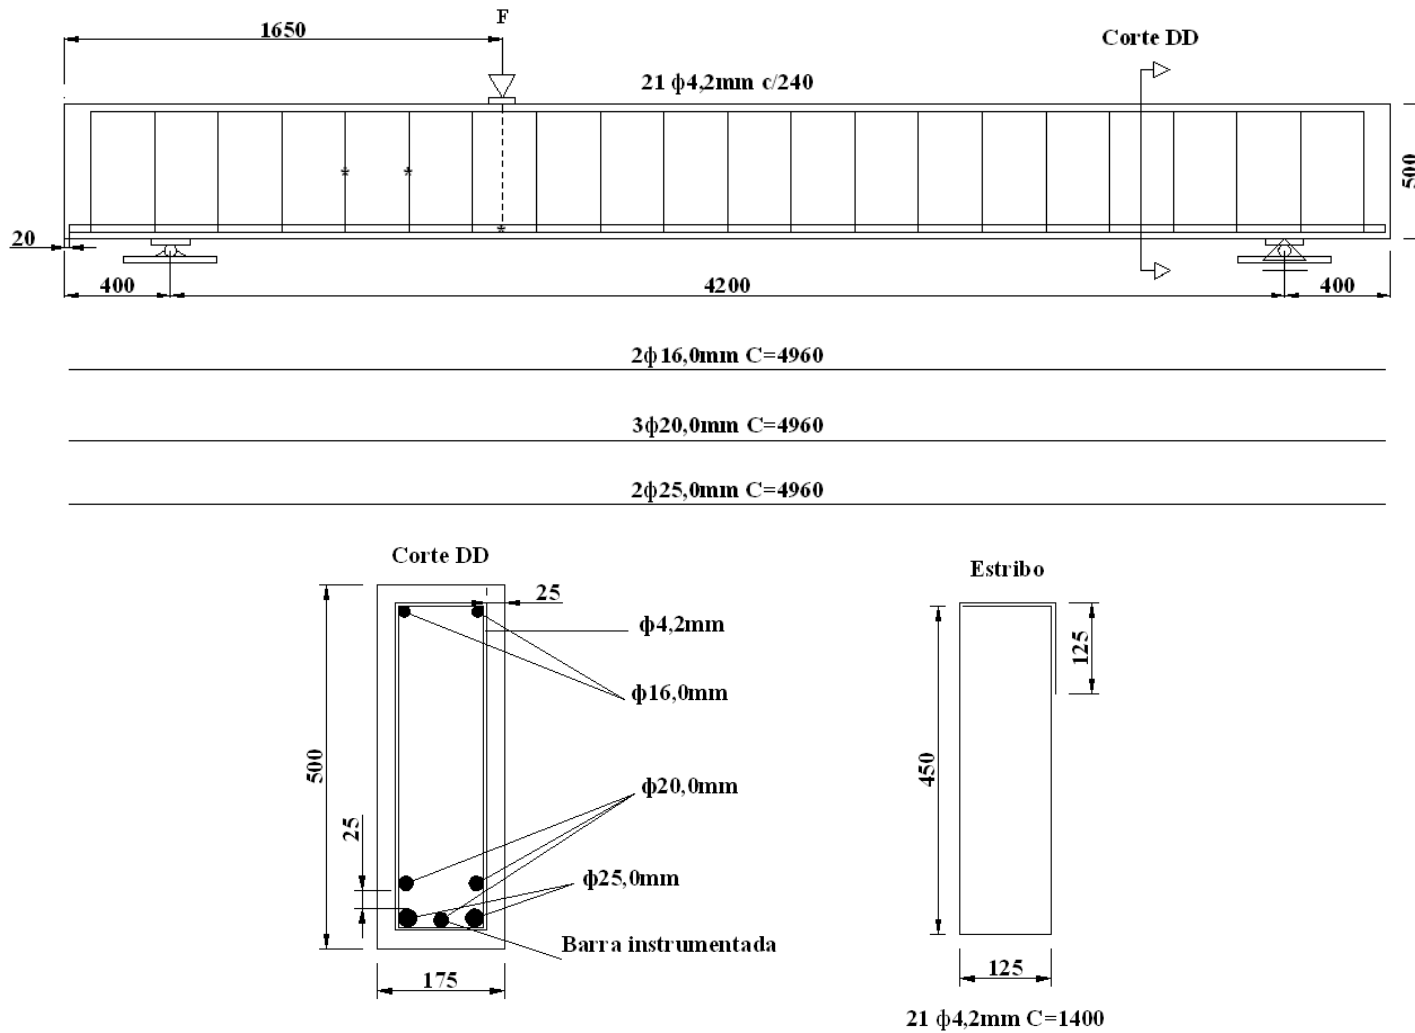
Armaduras e posicionamento dos extensômetros (\*) da viga V4 (dimensões em mm).
